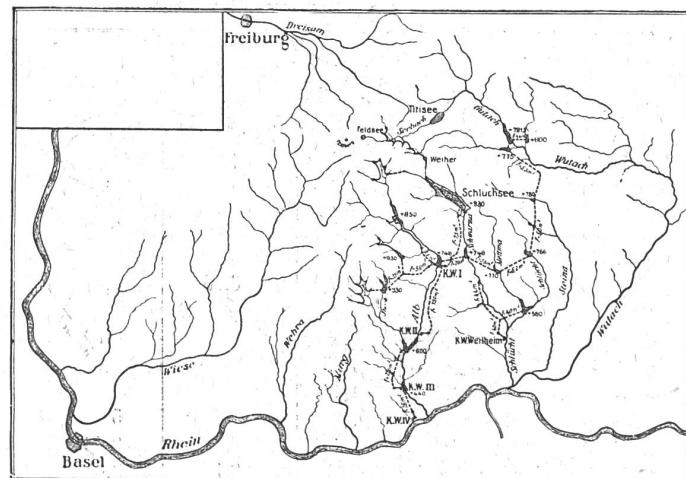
Übersichtslageplan - Entwurf „Seenkranz“.
